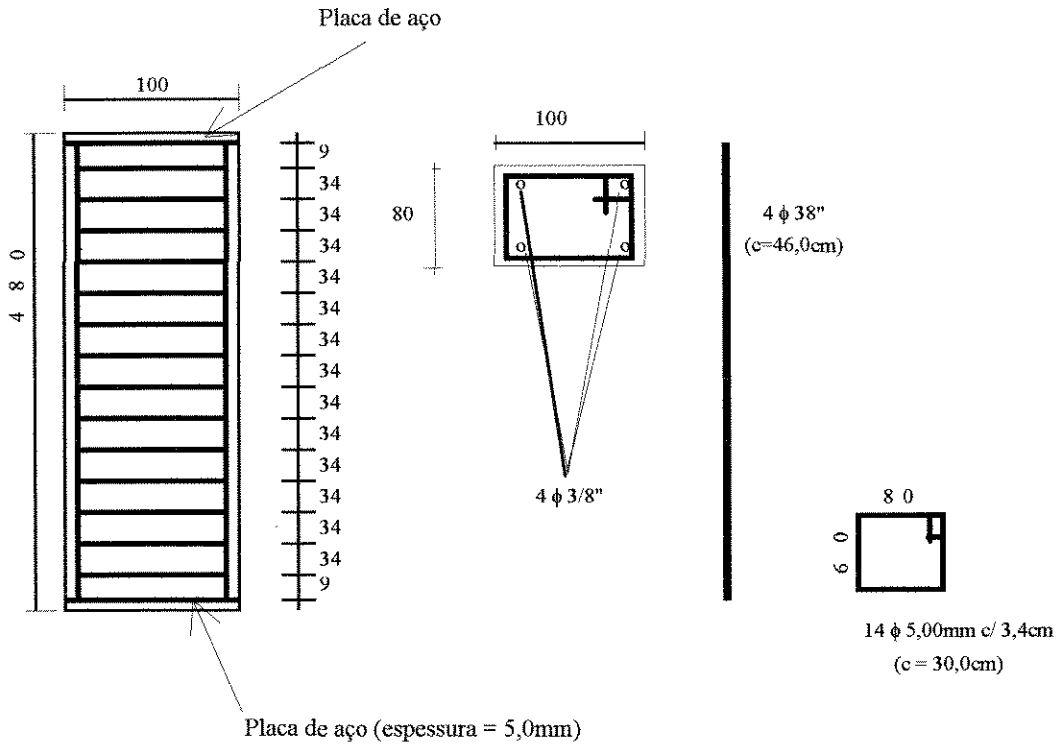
Detalhamento das armaduras dos pilares P8/10-150 e P8/10-175
